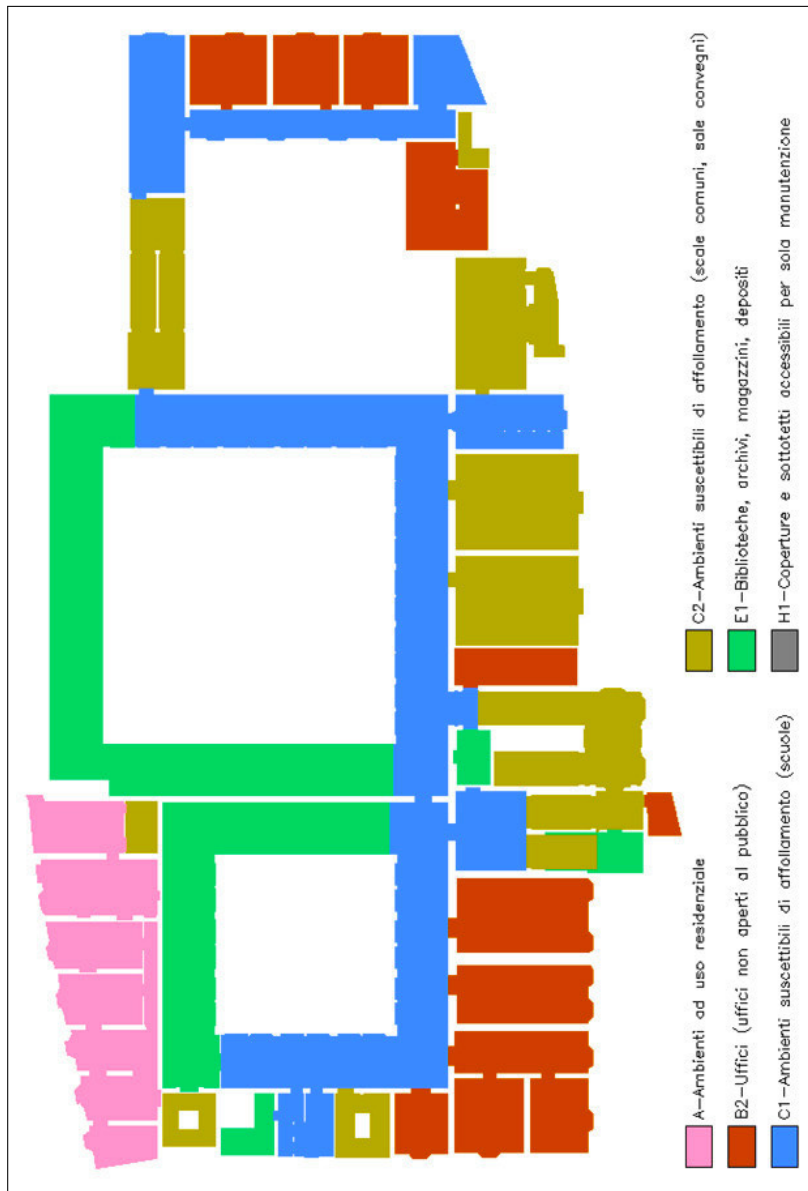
Pianta piano primo. Carichi divisi per ambiente.
